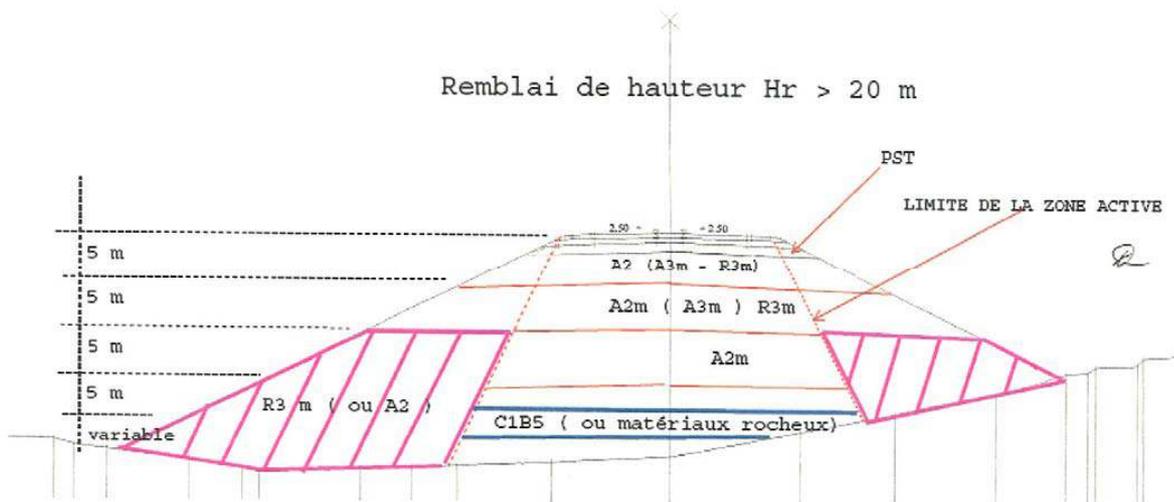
Schéma de montage d'un remblai de hauteur supérieur à 20 m [1].
